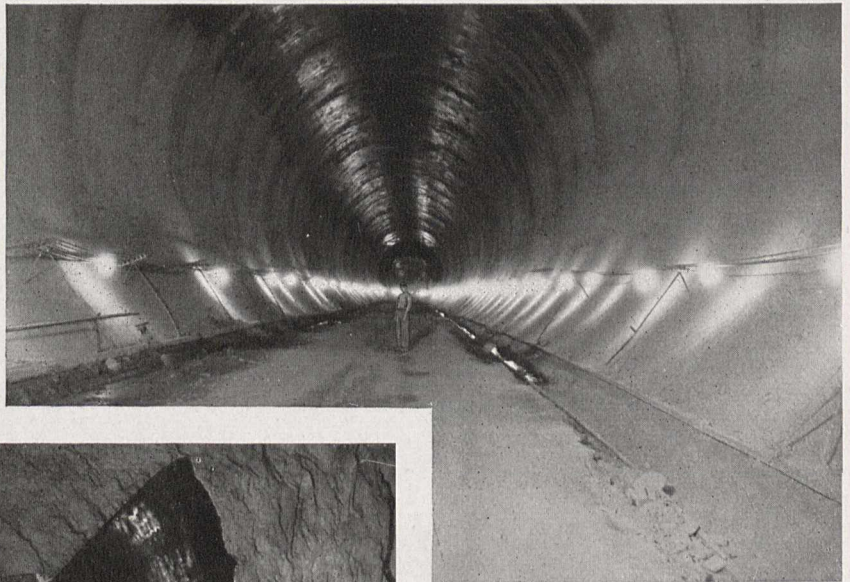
Der fertig betonierte Tunnel ist mit wasserundurchlässiger Farbe gestrichen
